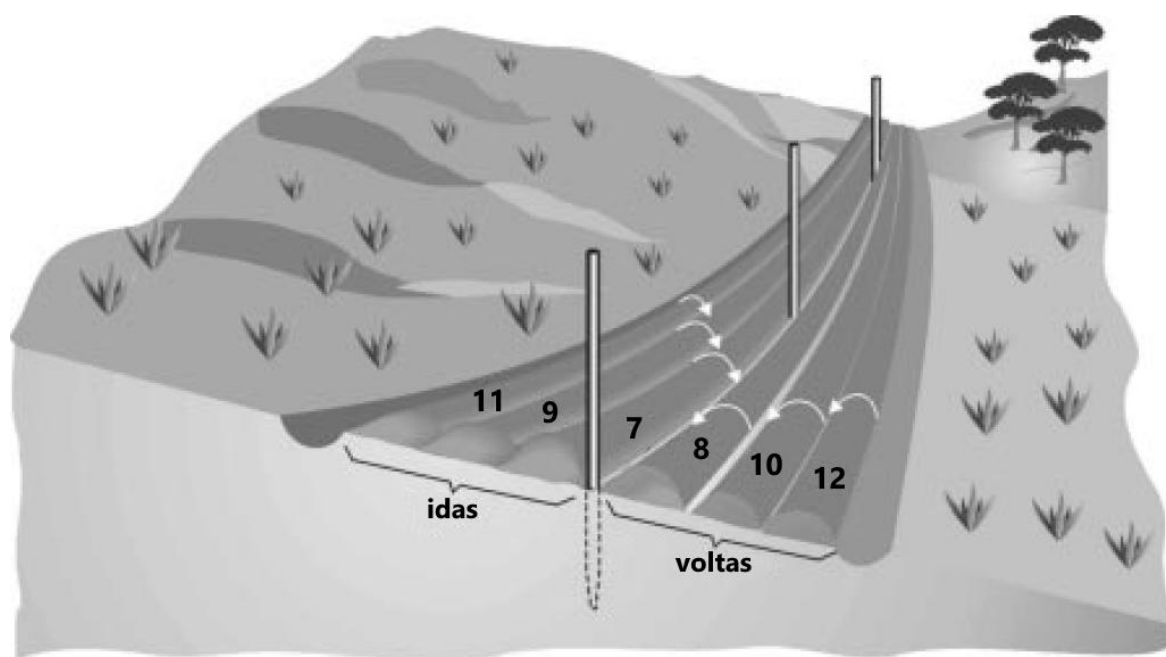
Ilustração da construção de terraço de base média, demonstrando o posicionamento das estacas e a segunda série do esquema de passadas do trator para levantamento do camalhão.
